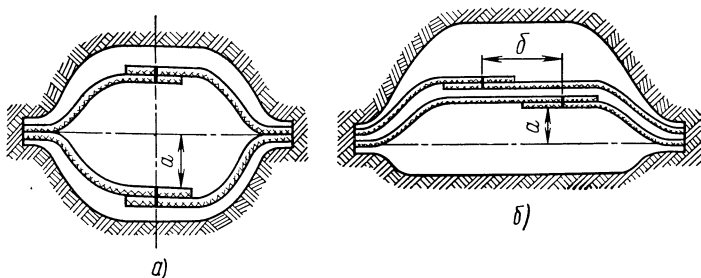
Выкладка кабеля в котлованах: а) по обе стороны от оси траншеи; б) по одну сторону от оси траншеи
